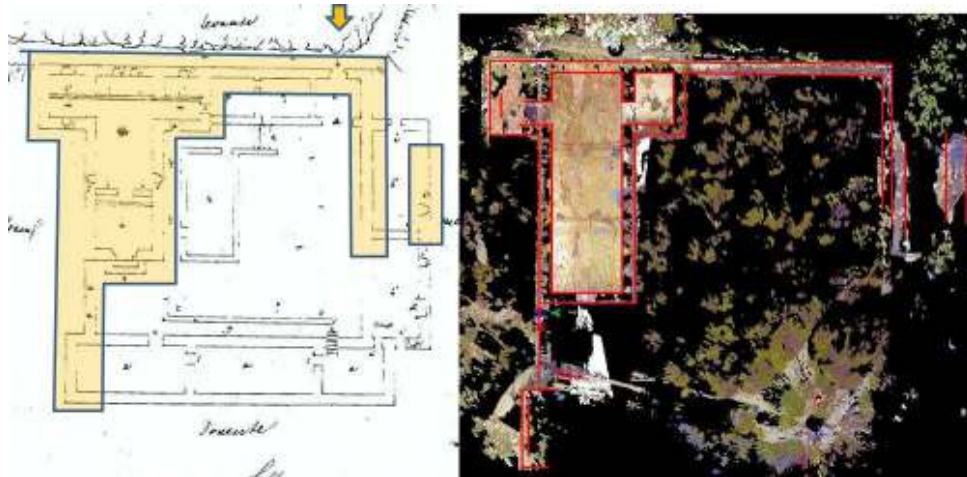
Confronto planimetria del Mellini / planimetria attuale
